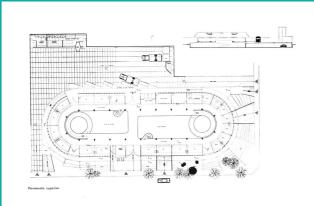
Planta Pavimento Inferior - Mercado Municipal de Pinheiros
